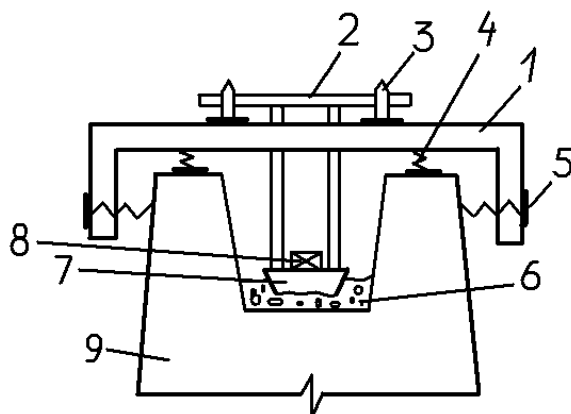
Схема улаштування опорної поверхні у склянці фундаменту:
